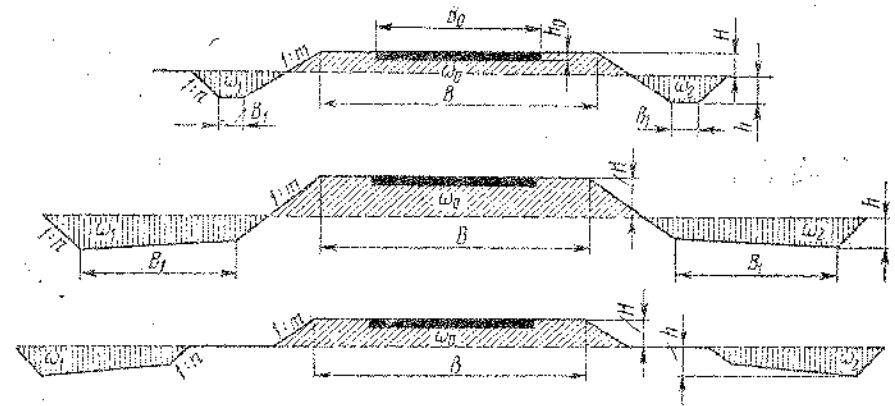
Поперечное уравнивание объемов грунта полотна, отсыпаемого из грунтов юветов и боковых резервов
